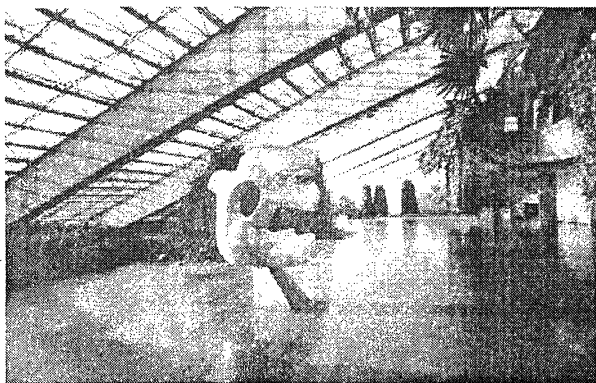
Vista de la Sala Villa Lobos donde se puede observar las vigas-pilares del edificio.
